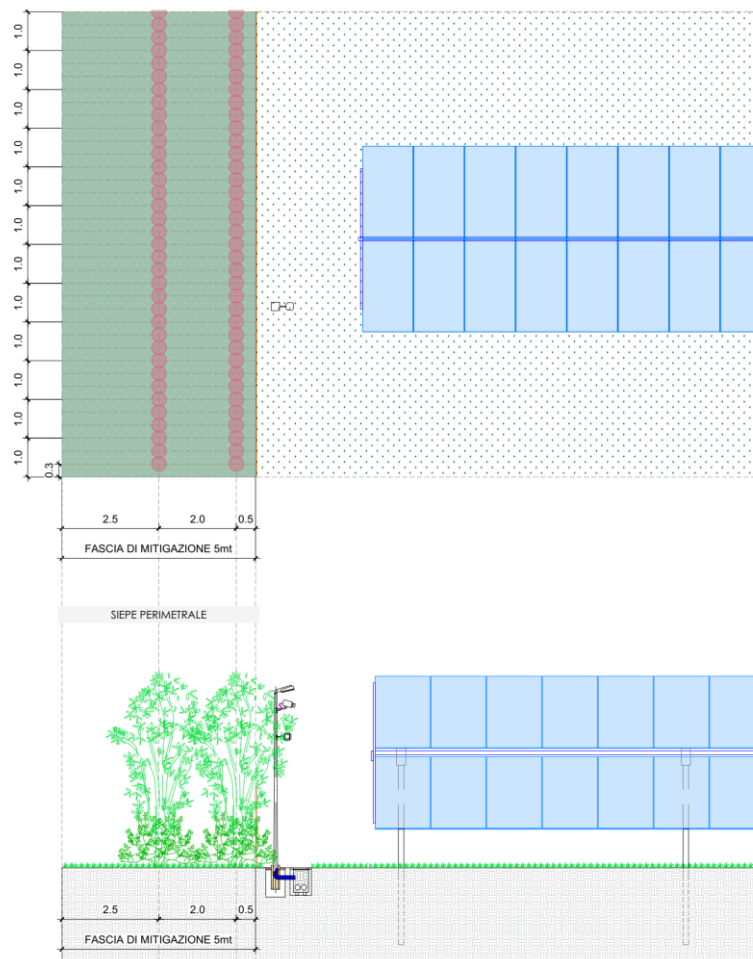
Prospetto in pianta ed in sezione della fascia di mitigazione perimetrale (estratto di PRO_TAV_29)
